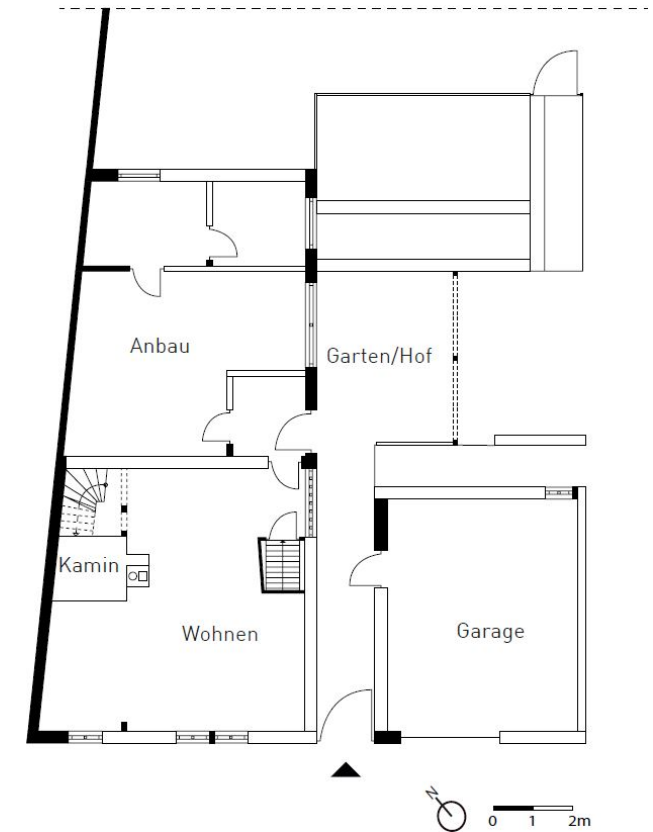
Erdgeschoss Grundriss, 2021.
